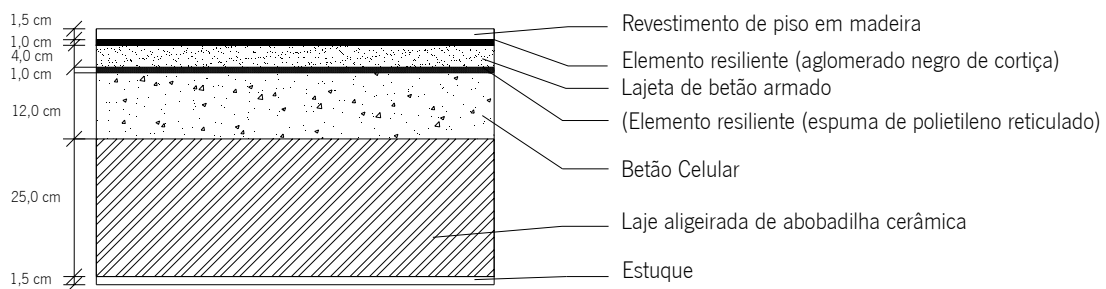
Pavimento de separação entre uma habitação e a zona de escritórios com soalho de madeira e com material cerâmico ou pético
